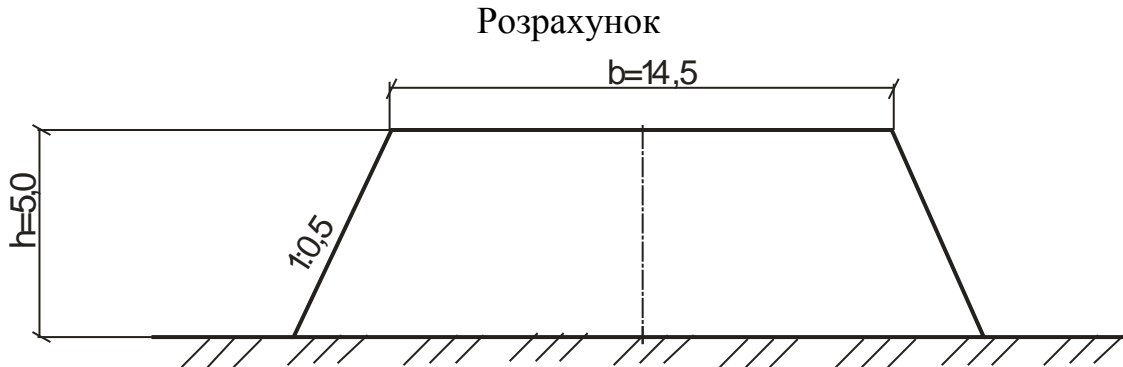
Розрахункова схема для визначення необхідного армування
